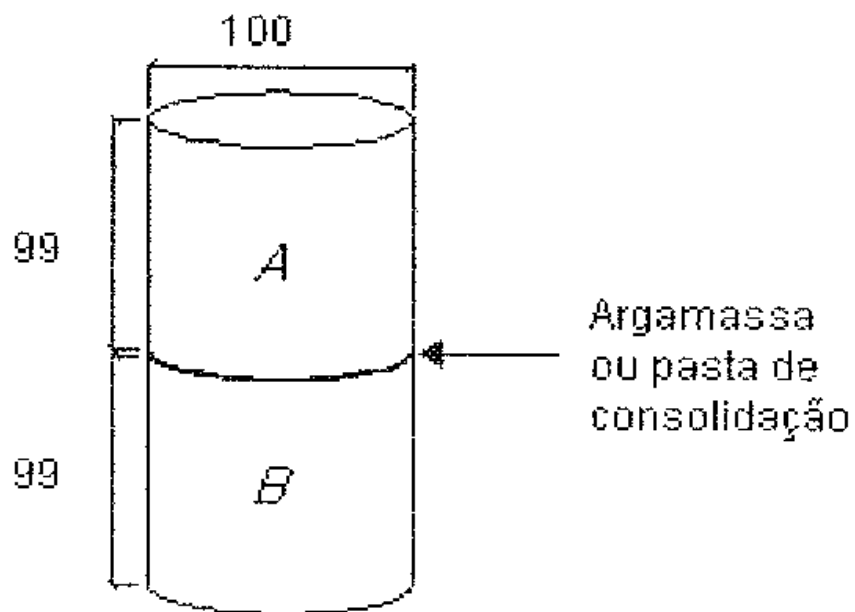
Esquema de montagem do corpo-de-prova tipo III - Dimensões em milímetros
